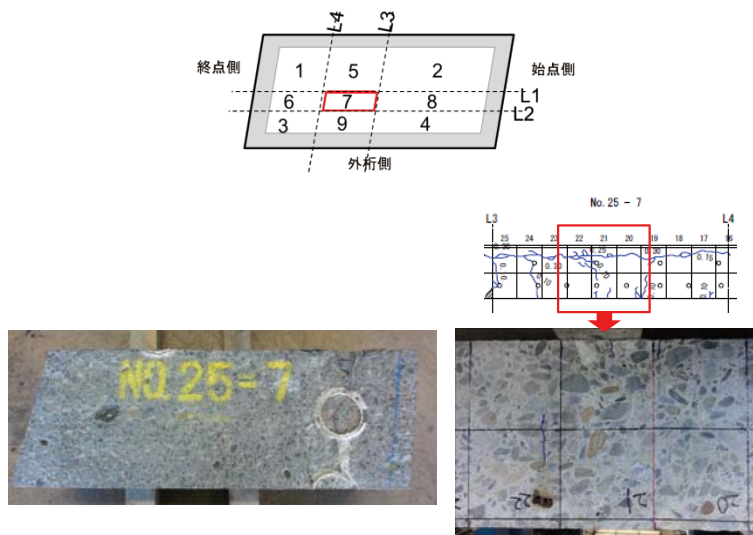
輪荷重走行試験後切断試験(供試体 No. 25 貫通ひび割れあり)
